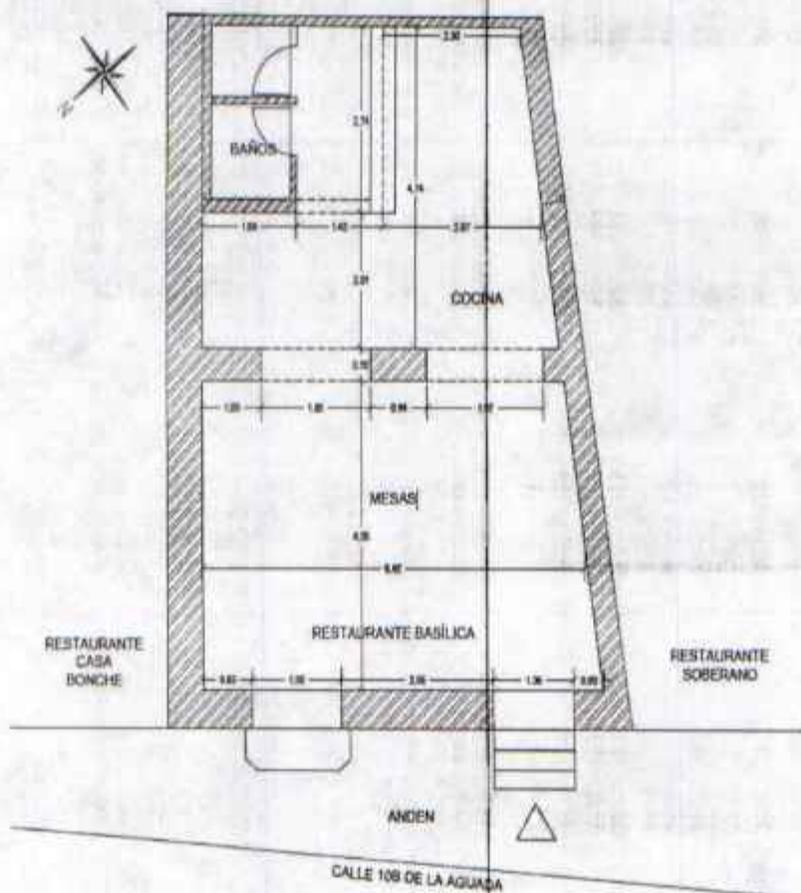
Plano RESTAURANTE BASÍLICA PIZZERÍA CAFÉ-Área privada
